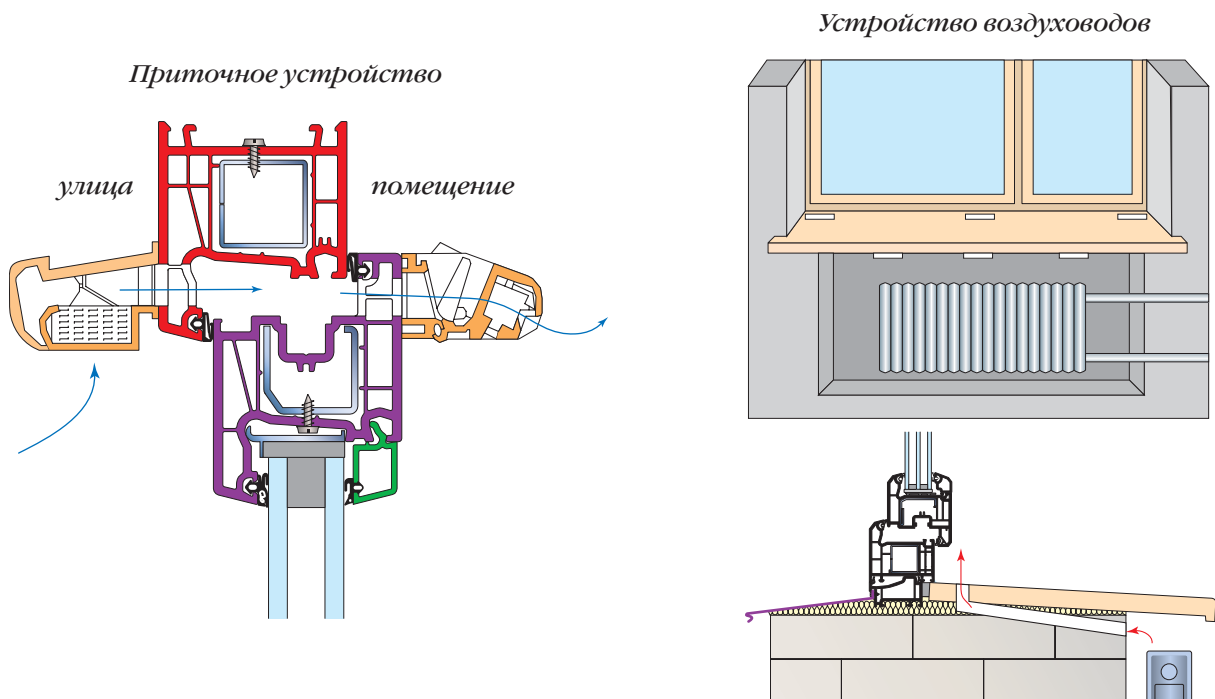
Устройства для вентилирования помещений и подогрева окна
